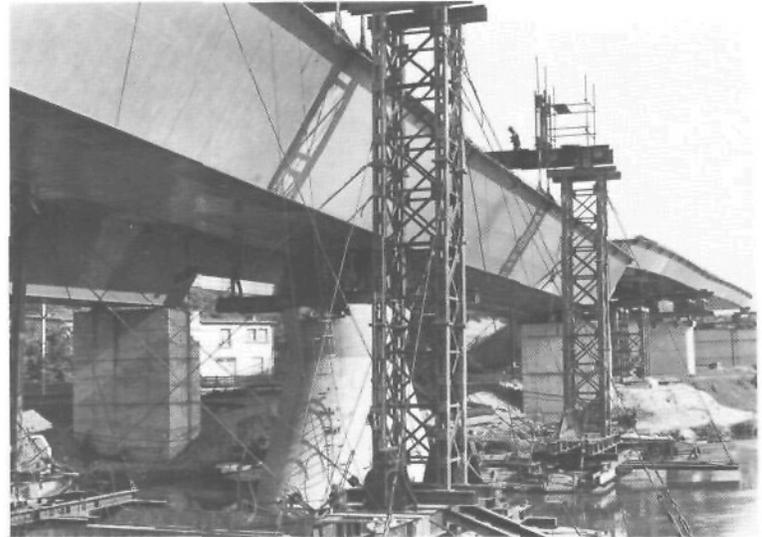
Le tronçon a été entièrement assemblé en atelier et acheminé par voie navigable. Noter la position des bigues qui tient compte des forces de levage différentes. Le tronçon est levé en quatre points. Le système étant hyperstatique, le levage doit être réalisé avec précautions pour équilibrer les réactions d'appui.
